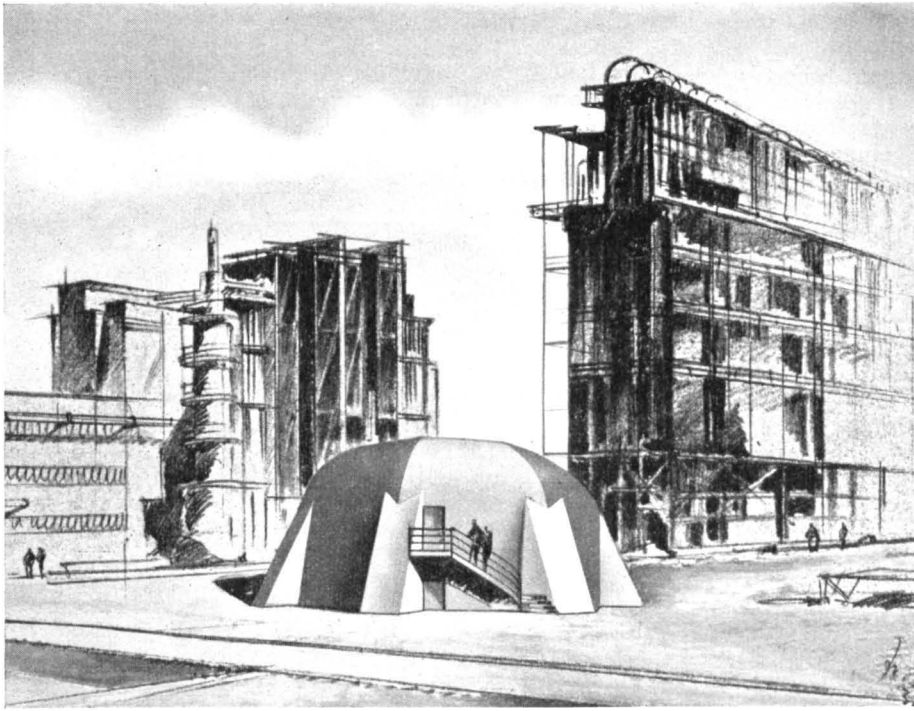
Prismatischer Großschutzraum mit Gewölbedecken.
